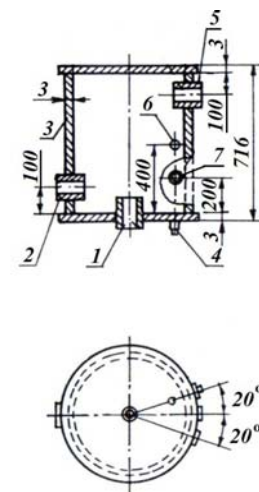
Расширительный бак типа 1 EO10-5EO10 емкостью 100–400 л: 1 – патрубок расширительной трубы; 2 – патрубок циркуляционной трубы; 3 – корпус бака; 4 – спускной патрубок; 5 – патрубок переливной трубы; 6 – патрубок сигнальной трубы; 7 – патрубок контрольной трубы
